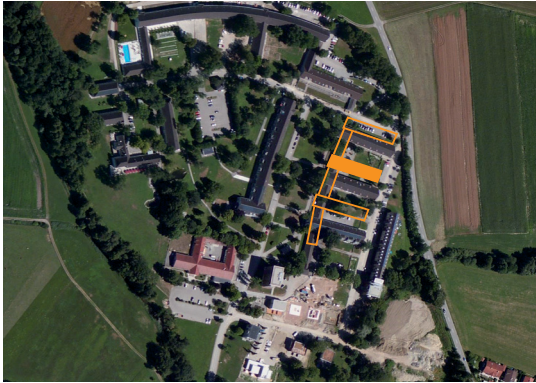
Lageplan B&O-Gelände Bad Aibling mit DFI und Ansicht Bestandsgebäude
